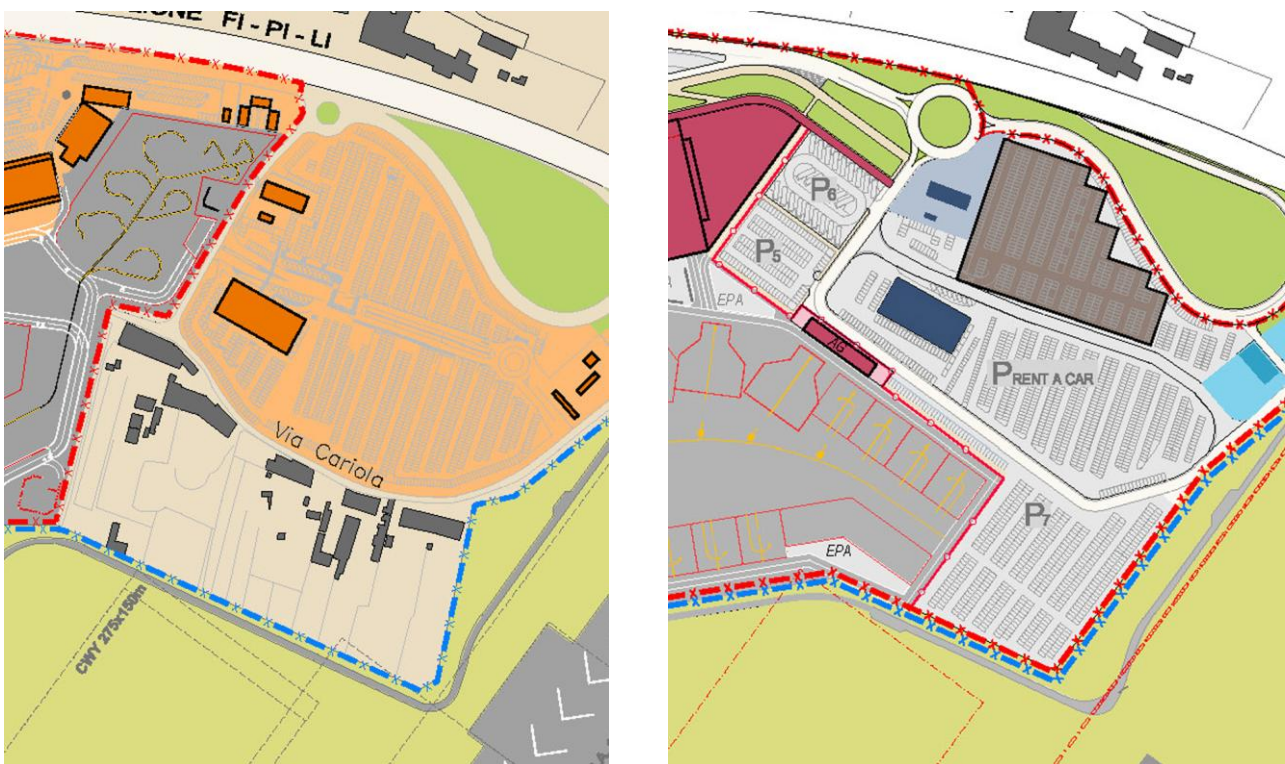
Piazzale AG – Situazione attuale e planimetria di progetto a confronto
